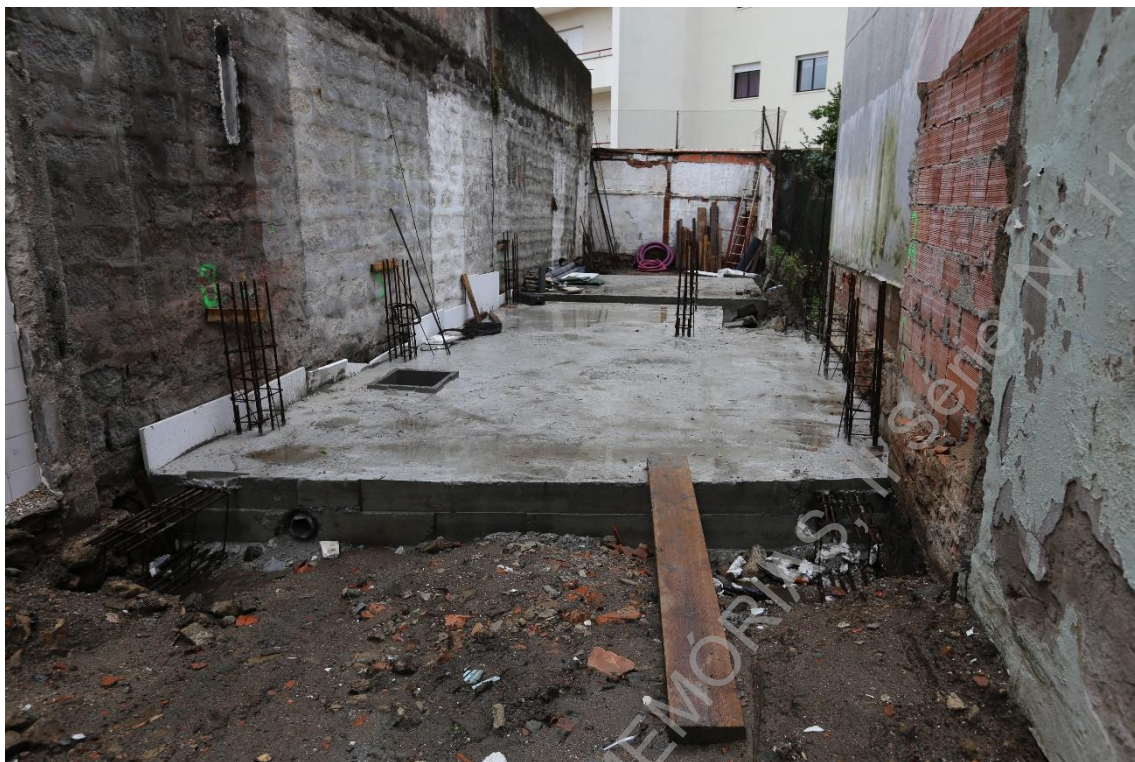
(IMG_9136) – Pormenor da betonagem da área escavada.
